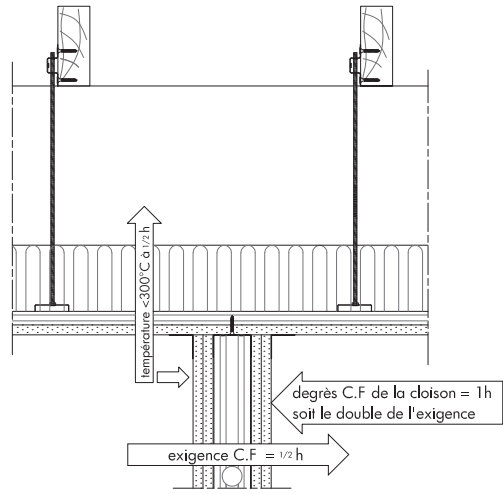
Cloisons fixées sous plafond - ERP type U
